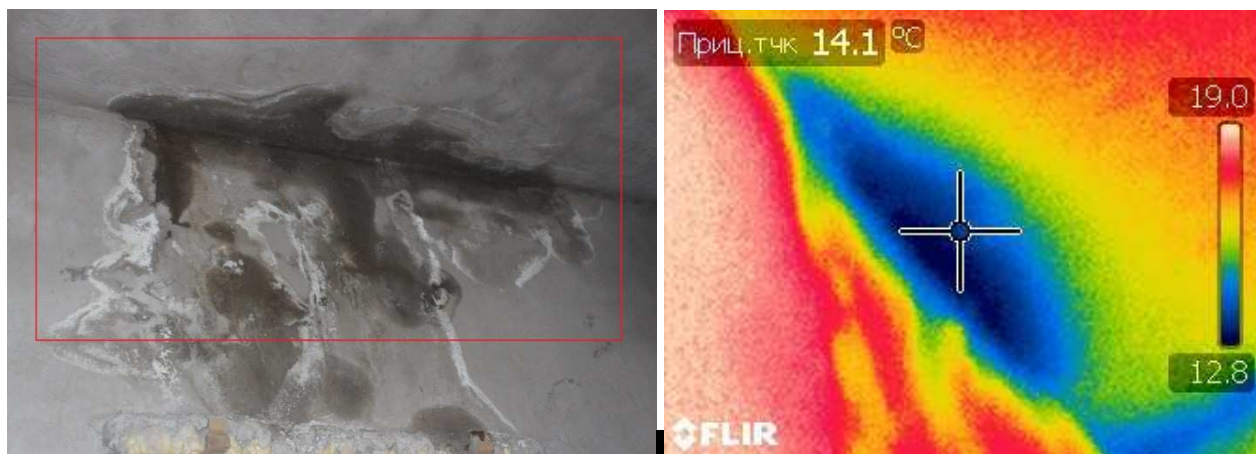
Теплопотери в уровне примыкания перекрытия с кирпичной внутренней стеной в месте под дверным проемом выхода на крышу
